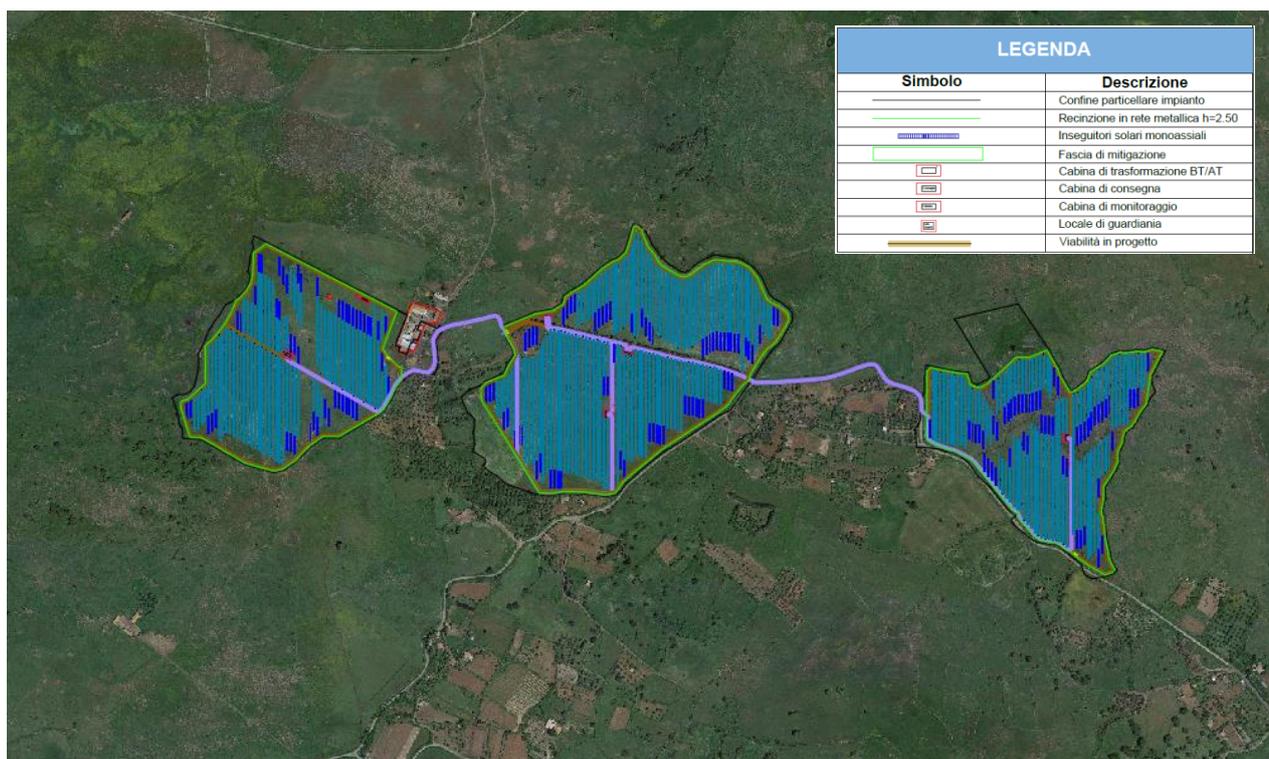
LAYOUT PLANIMETRICO DELL'AREA D'IMPIANTO
